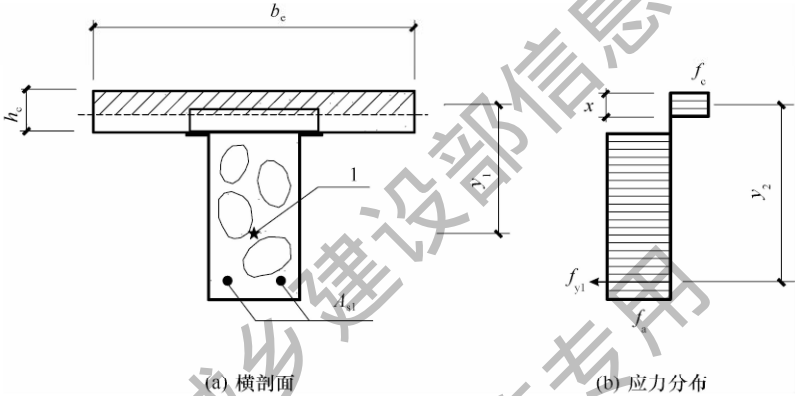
塑性中和轴在钢筋混凝土翼板内的梁截面应力分布
